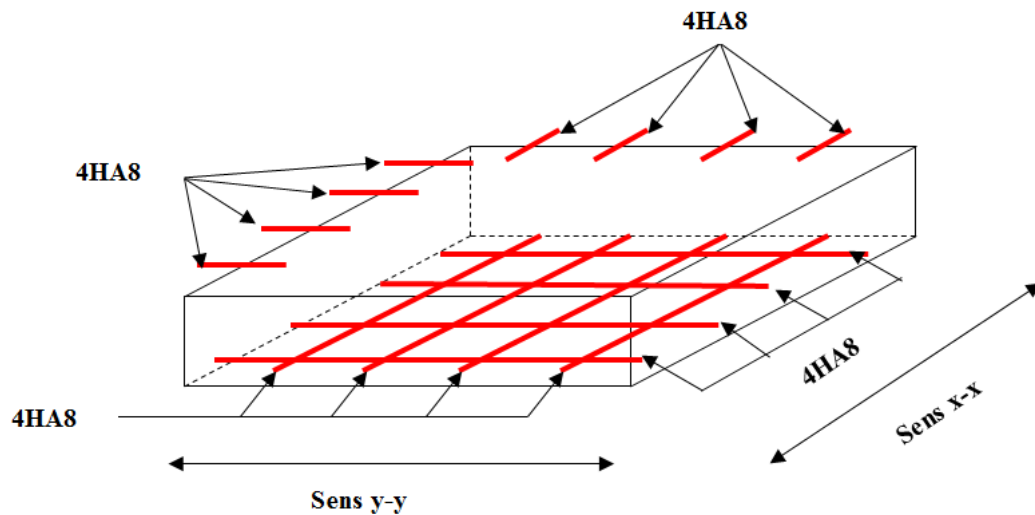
Schéma de ferrailage de la dalle pleine au-dessous de l'ascenseur.
